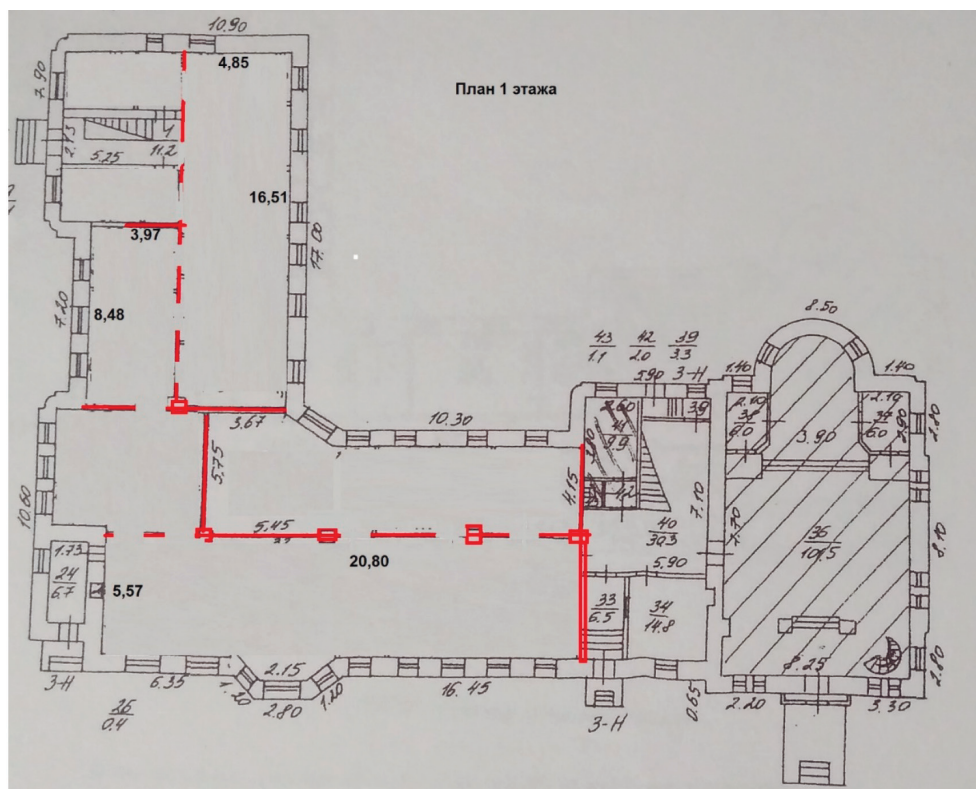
План 1-го этажа общежития сестер милосердия.
